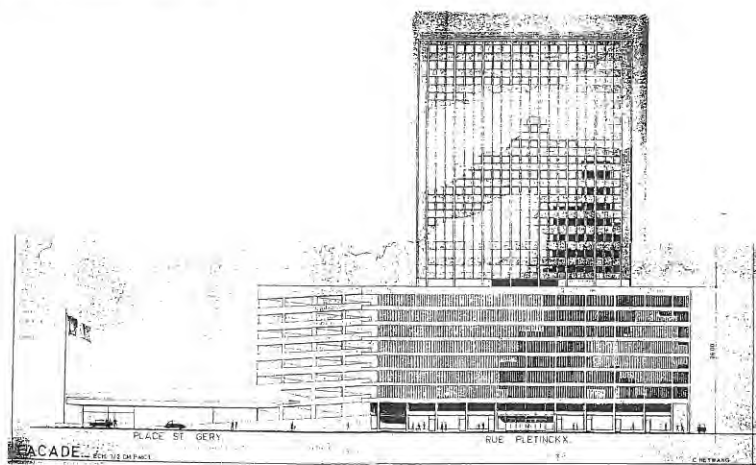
Projet d'immeuble sur la place Saint-Géry; architecte C. Heywang, vers 1965 (Archives de la Ville de Bruxelles).
